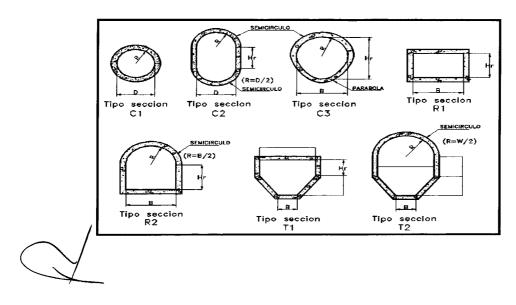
Tipos de sección transversal y parámetros de dimensiones de colectores
